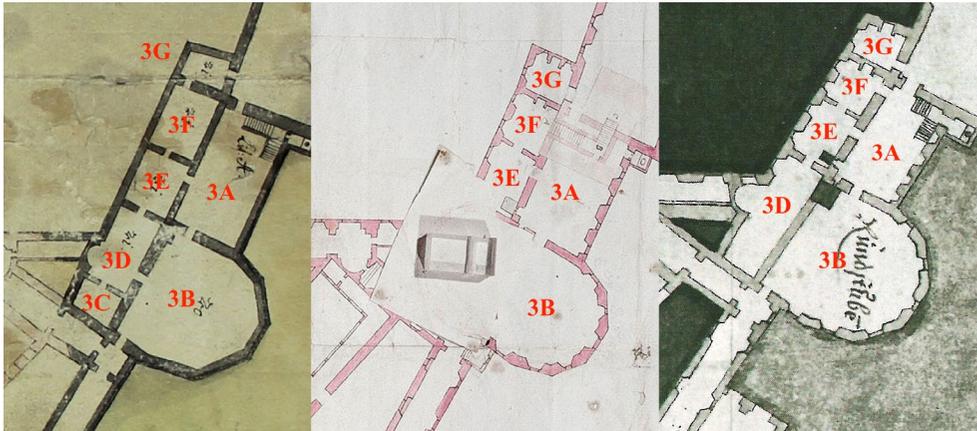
Rundstubenbau, Montage, Brandplan 1750, Pariser Plan 1630a und Tambachplan 1630, Etage 3, JL
